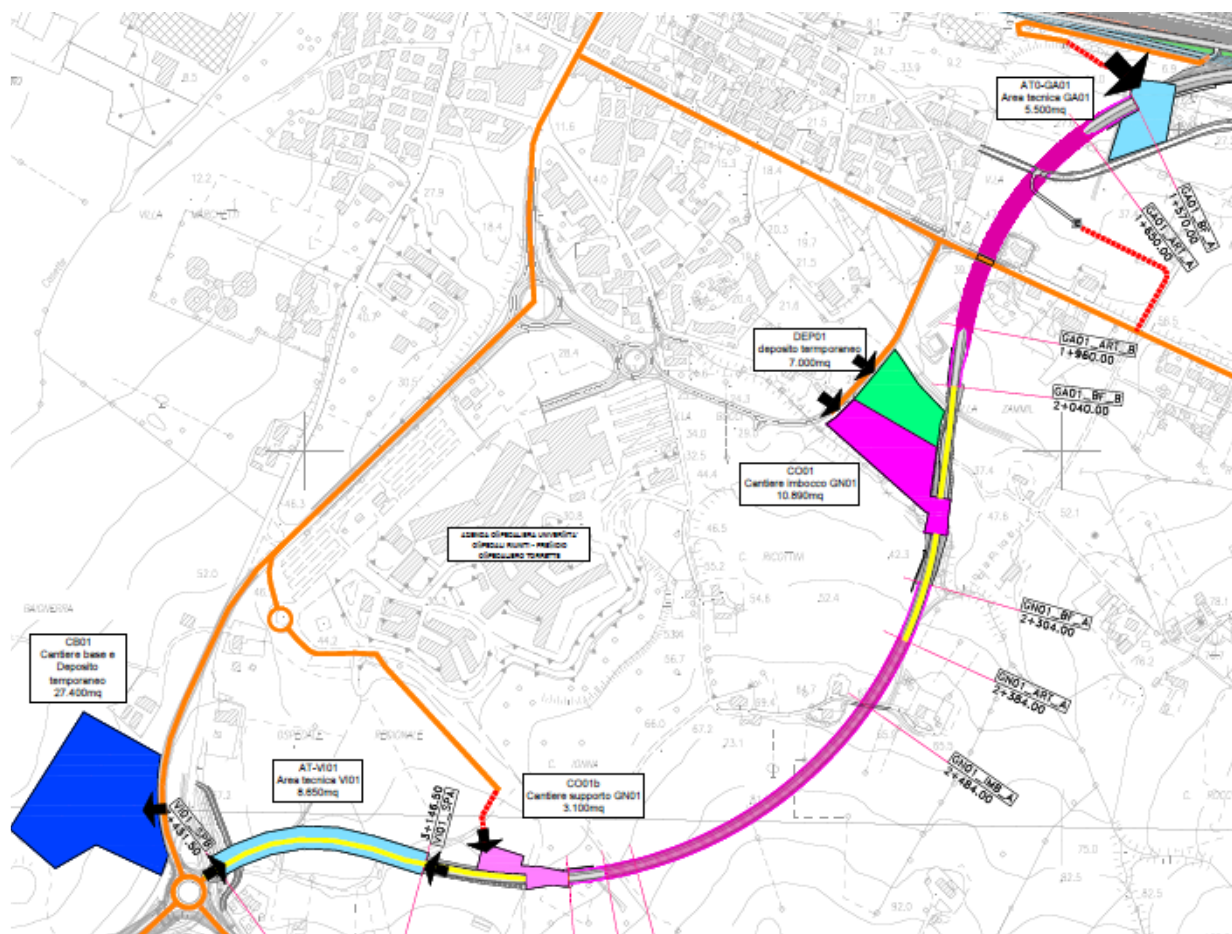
Tavola T00IA00AMBPL01\_A-Planimetria area di cantiere e viabilità di servizio .
